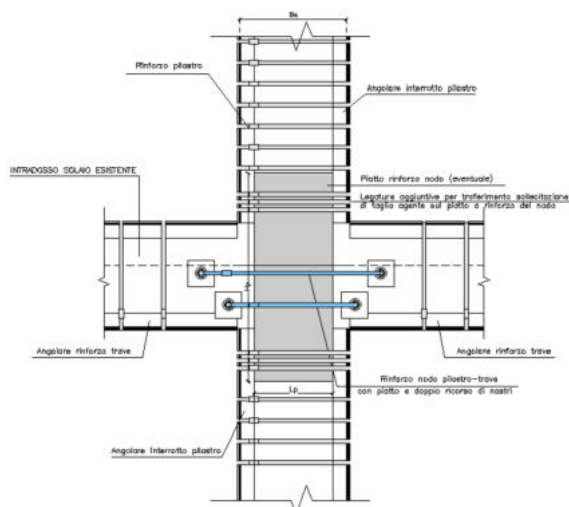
Particolare tipologico: Sistema CAM® applicata al nodo trave-pilastro in facciata, prospetto.
